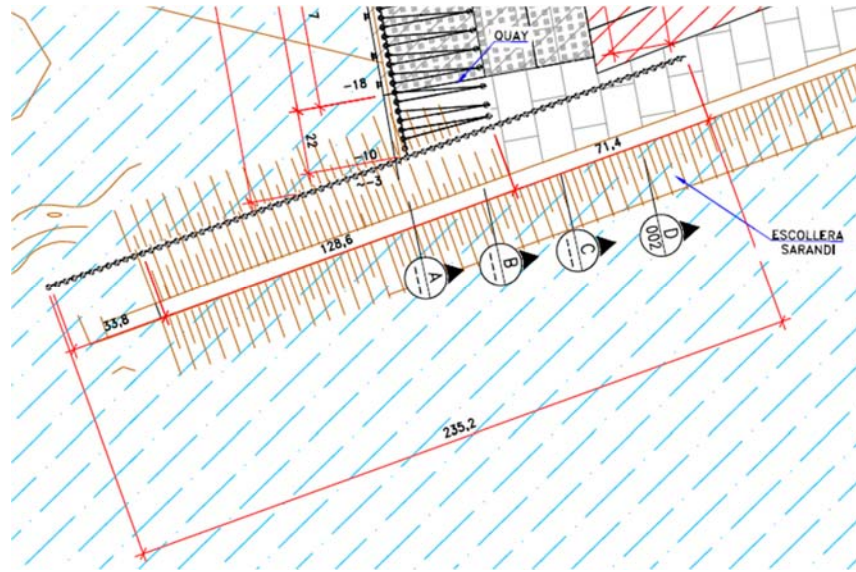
Protección de la escollera Sarandí, muro combi-wall de 235 m de longitud.
